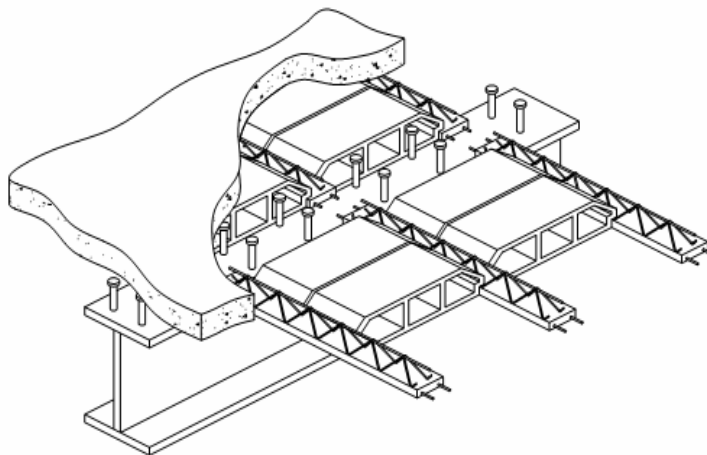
Viga mista formado por laje de vigotas pré-moldadas – MALITE (1990)
